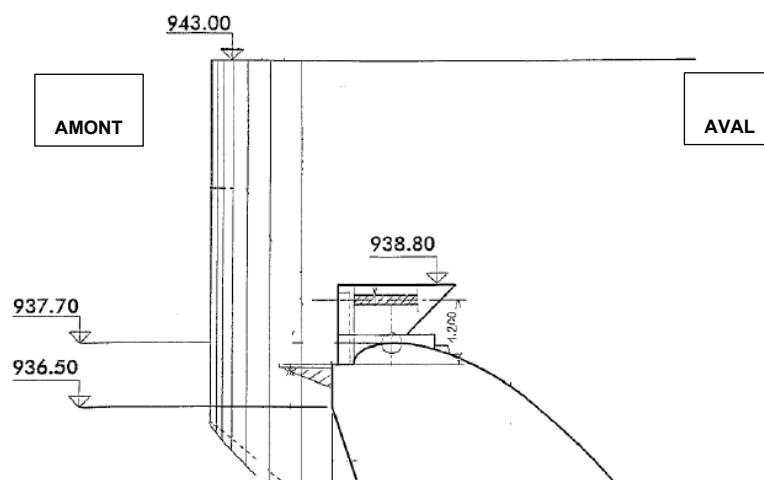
Evacuateur de crues du barrage - vue en coupe d'une hausse HYDROPLUS
